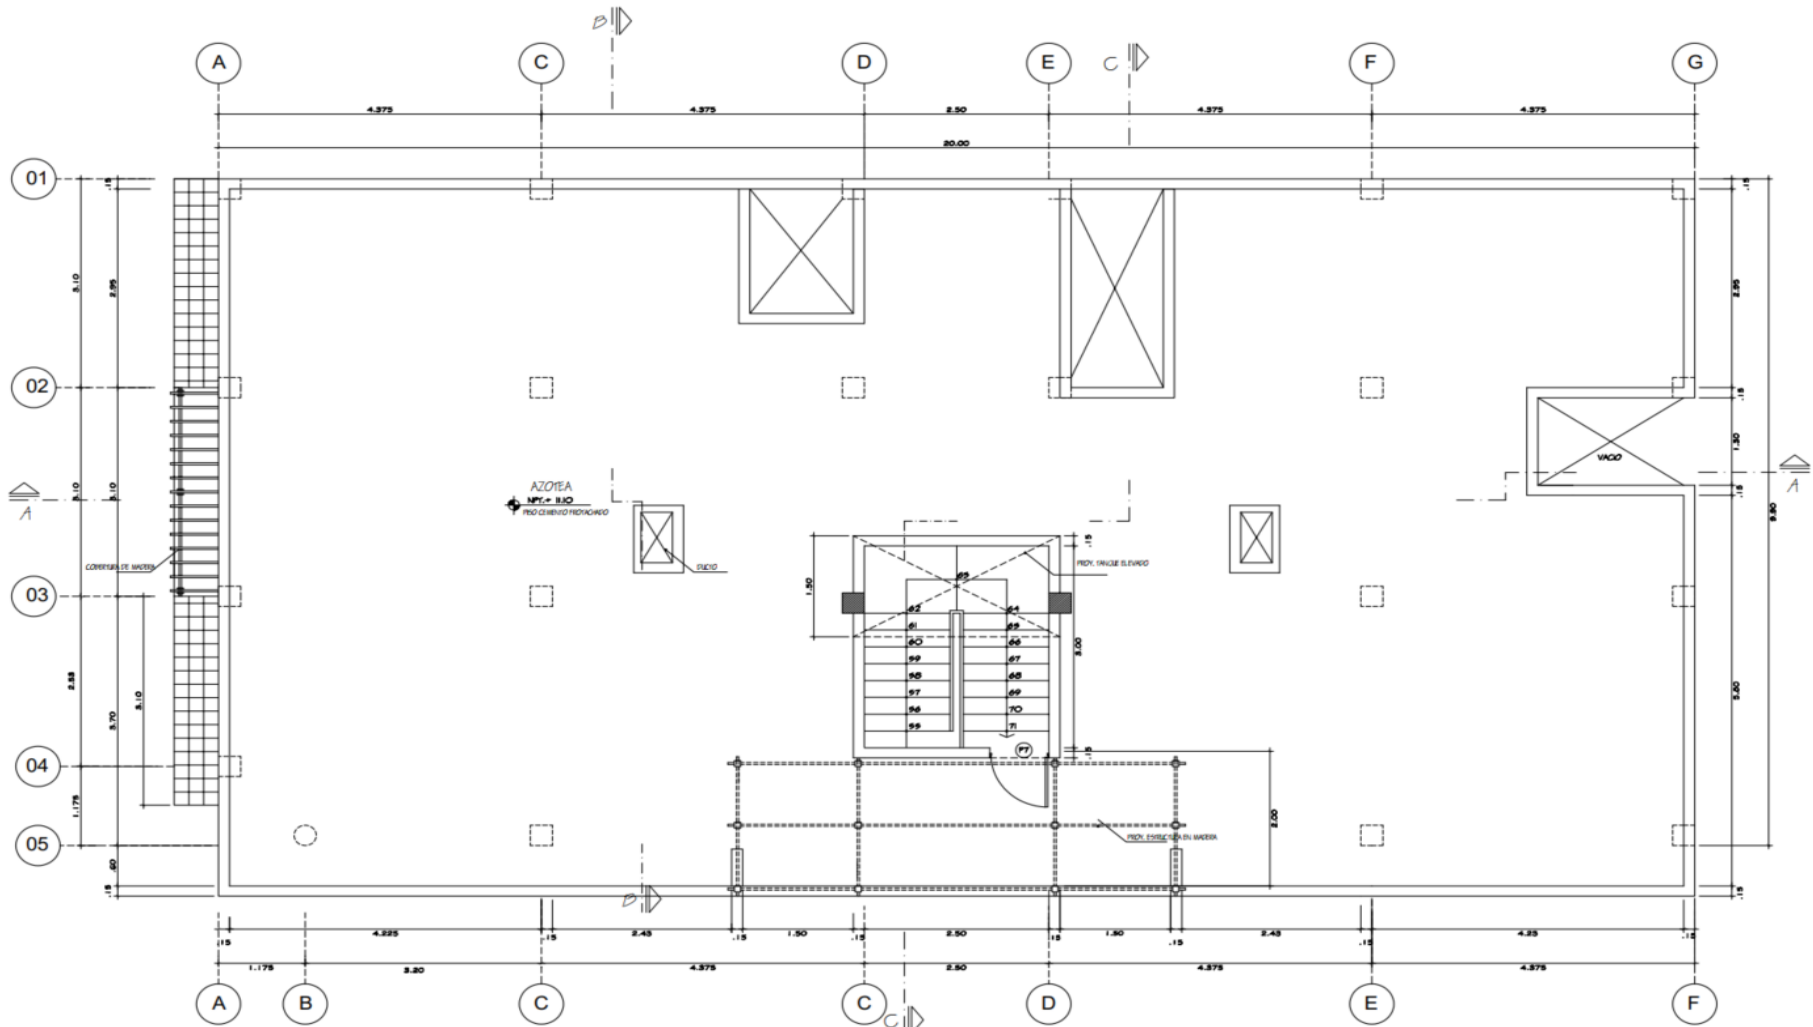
Distribución arquitectónica primera planta. Nota: Elaborada por la autora.
